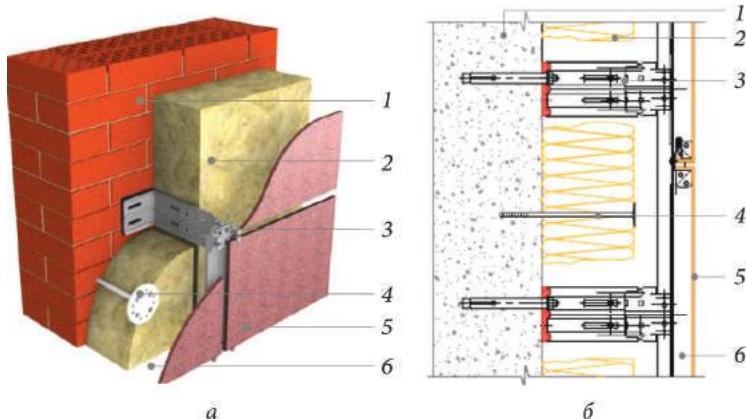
Навесная фасадная система ТН-ФАСАД Вент: а — общий вид; б — схема; 1 — несущая стена; 2 — утеплитель: минераловатные плиты ТЕХНОВЕНТ; 3 — несущая подсистема; 4 — тарельчатый фасадный анкер; 5 — облицовочные панели; 6 — вентилируемый зазор
